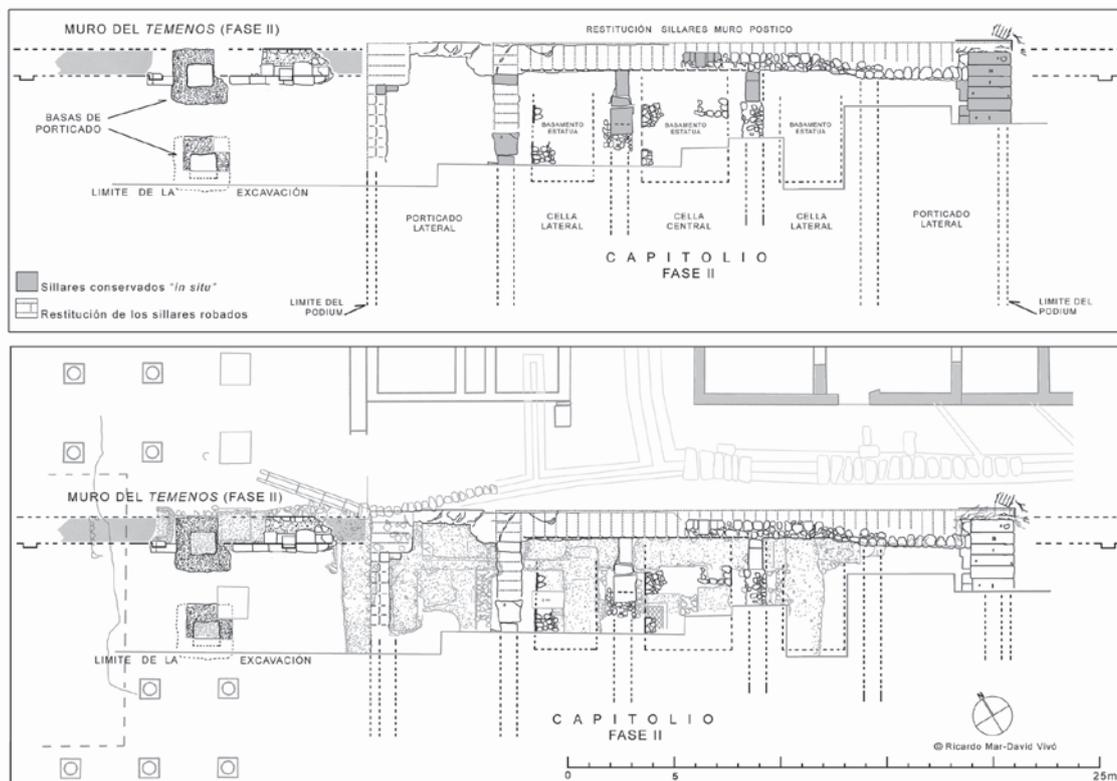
Capitolio. Segunda fase. Construcción de un templo del tipo *peripteros sine postico* sobre un podio levantado con muros y cimentaciones de sillería.
